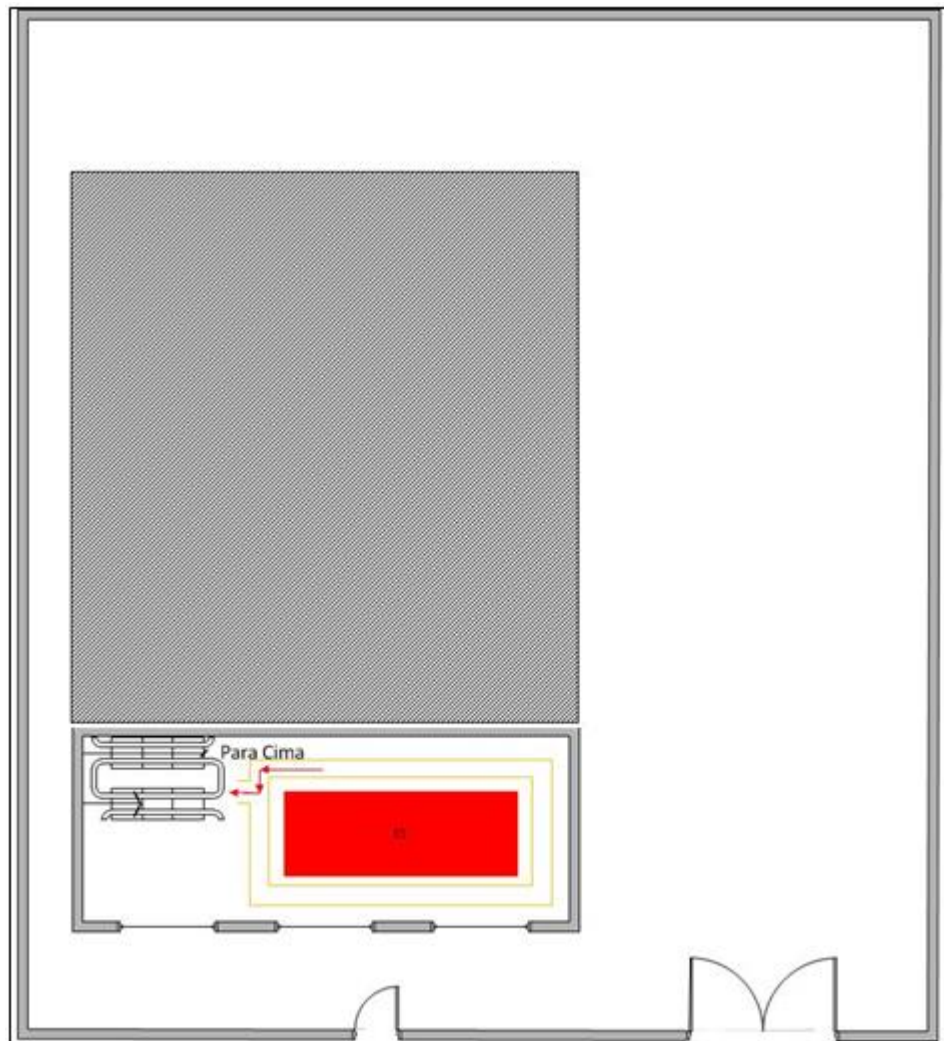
Planta baixa otimizada do primeiro andar da empresa C
